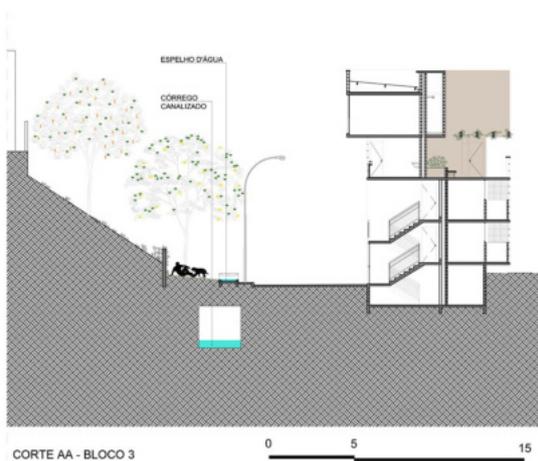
Corte AA. Fonte: ArchDaily, 2010.
